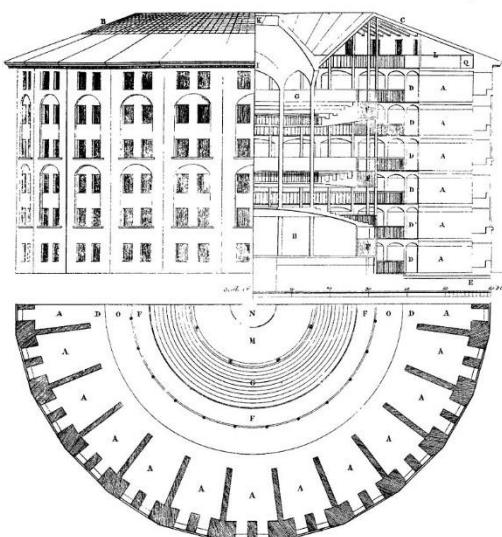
Planta y sección de un modelo panóptico (1780).
